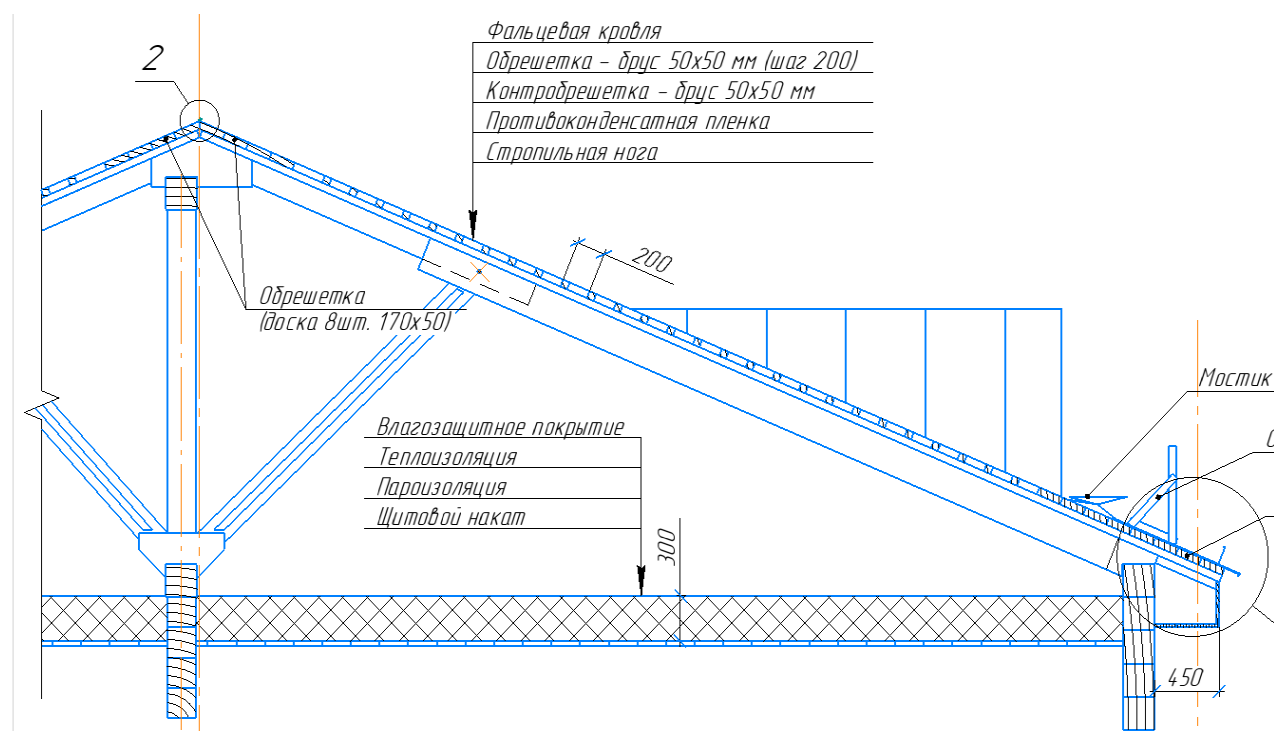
Проектное решение конструкции чердачного перекрытия
